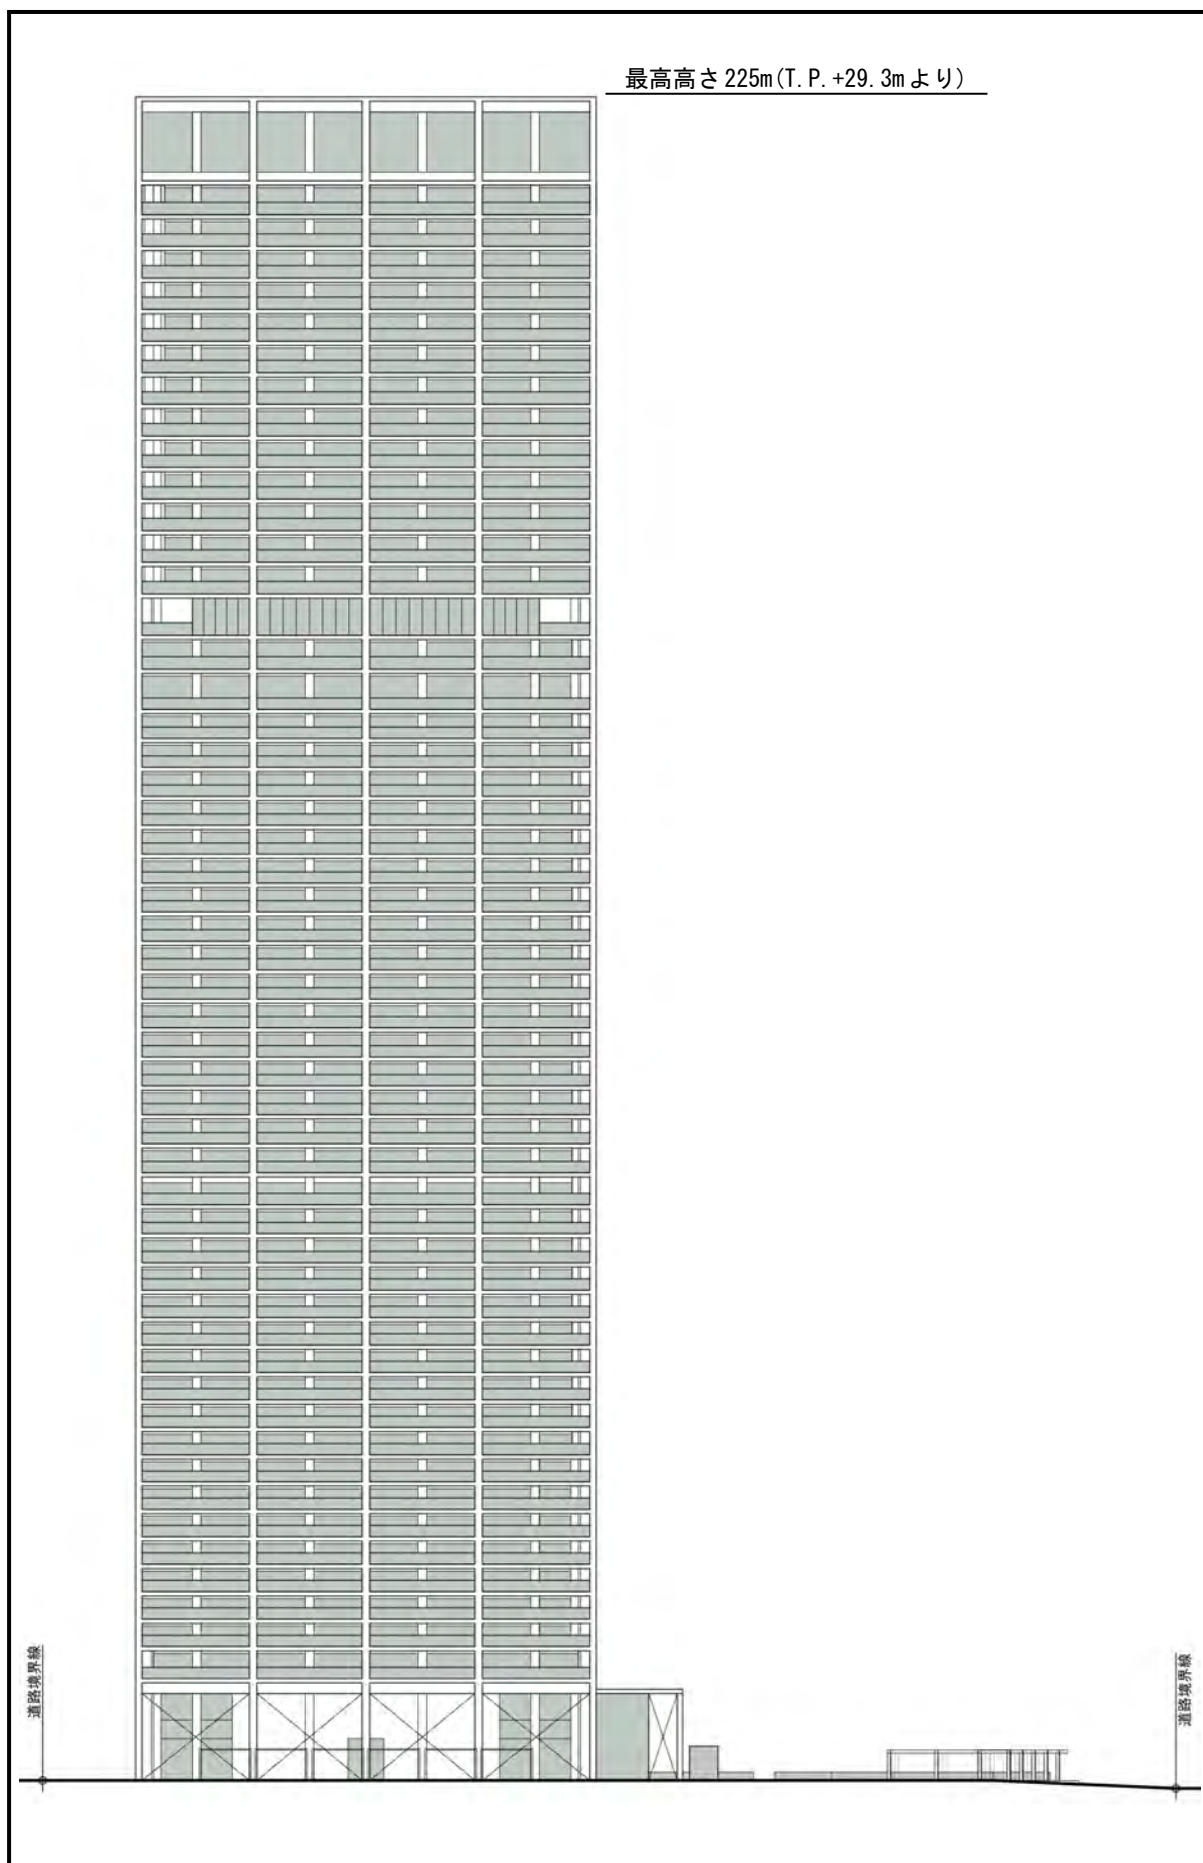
(7) 立面図 (西立面図 S=1:1,000) 【変更前】
